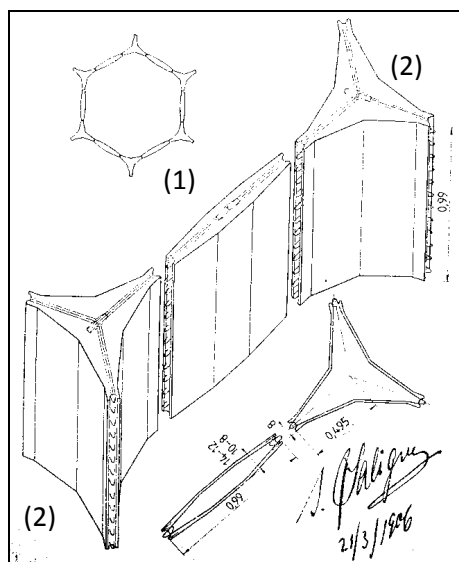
Tipurile de elemente prefabricate din beton armat folosite la execuția celulelor silozurilor de cereale de la Constanța, proiectant inginer Anghel Saligny, 1906. Sursa [1].
